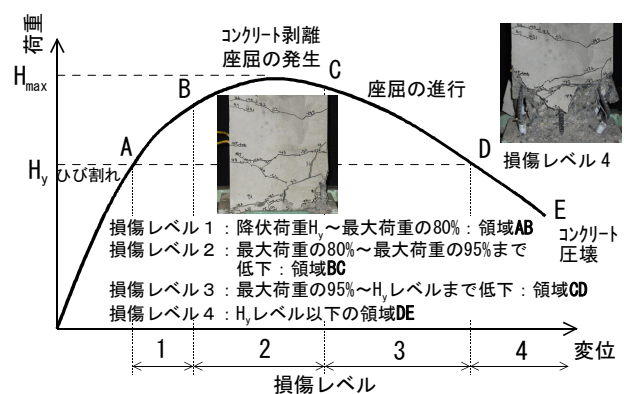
鉄筋コンクリート柱の損傷レベル（一例）
